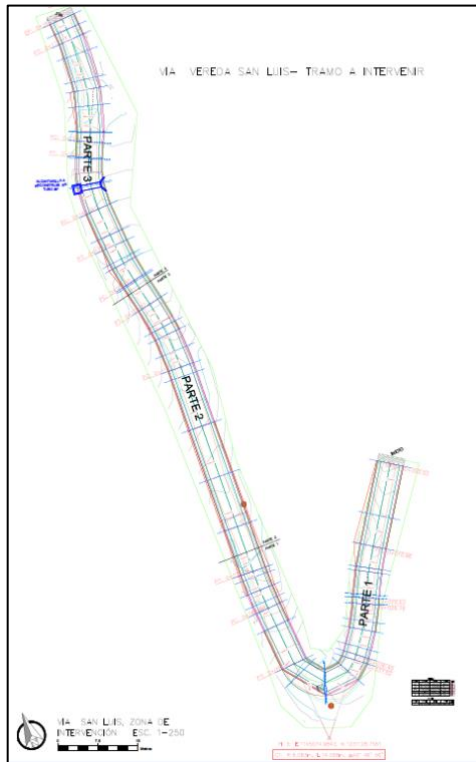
Imagen de planta del tramo 1 del proyecto de Málaga-Santander
